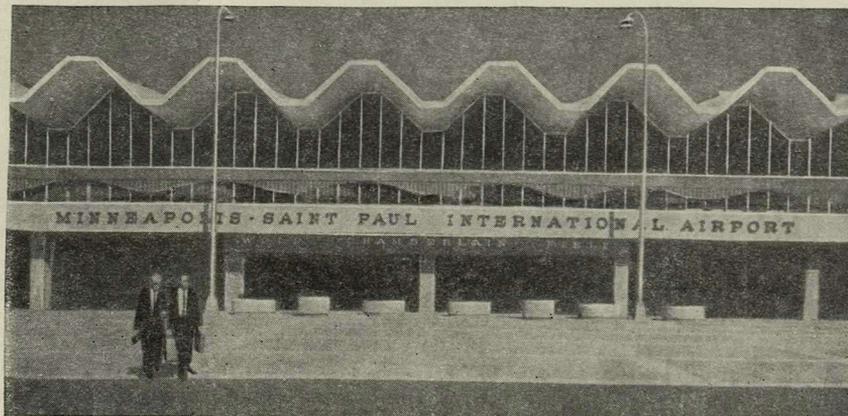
Складчатое железобетонное покрытие аэровокзала (США)
